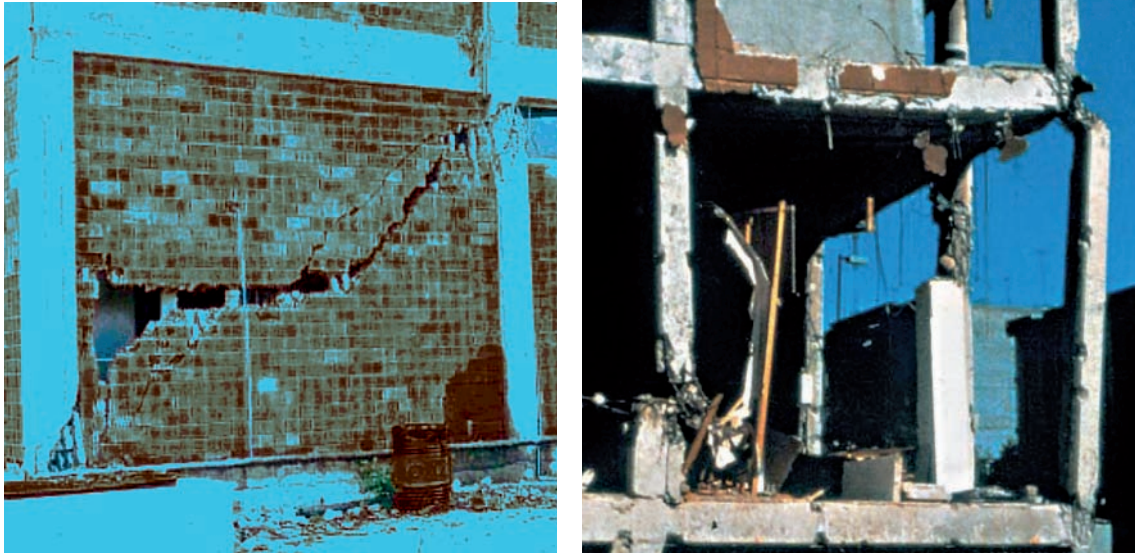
Versagen von Stahlbetonstützen nach einem Erdbeben durch die zusätzlichen Beanspruchungen durch Ausmauerungen nach einem Erdbeben
